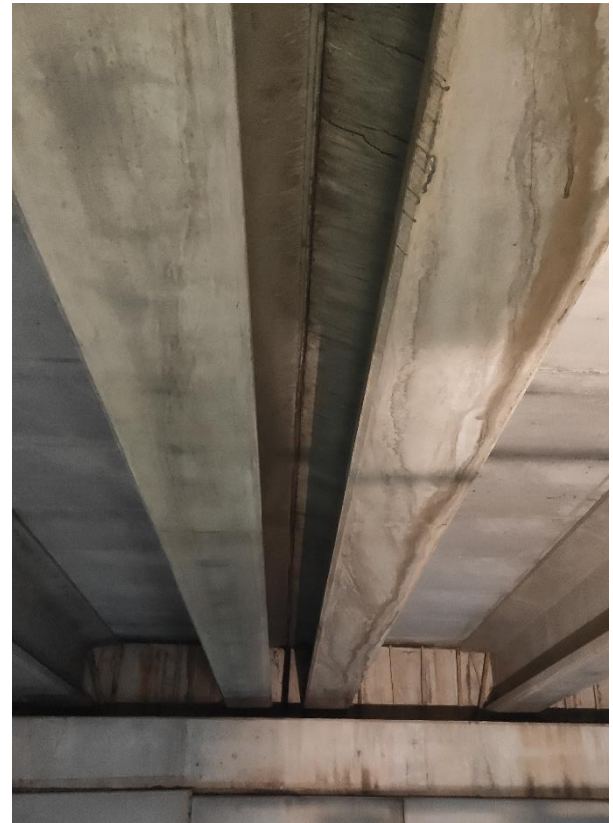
Estado general de la fascia inferior de las vigas pretensadas sin fisuración aparente. Manchas en los paramentos de hormigón propias del envejecimiento de la estructura.
